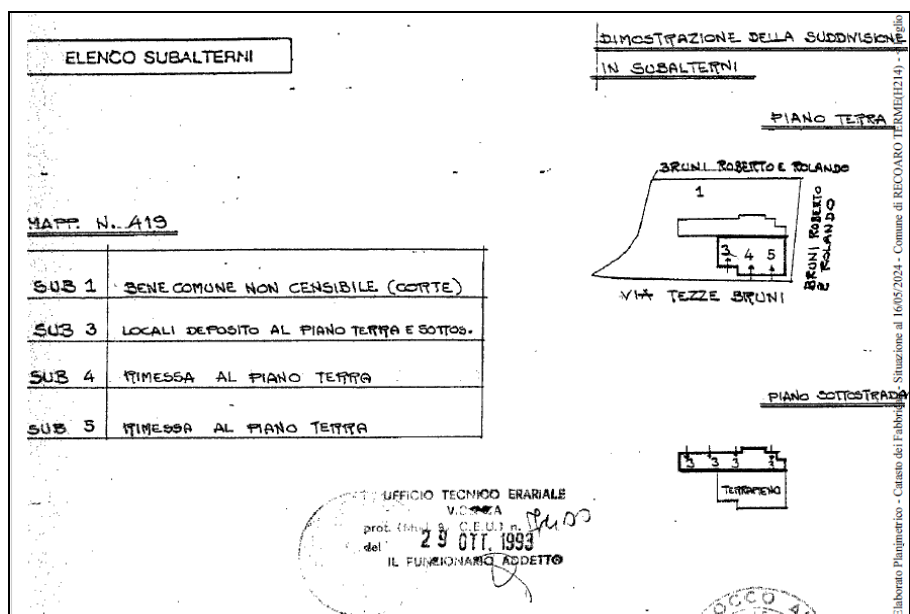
Estratto planimetria ed elenco subalterni (Allegato N.4)
